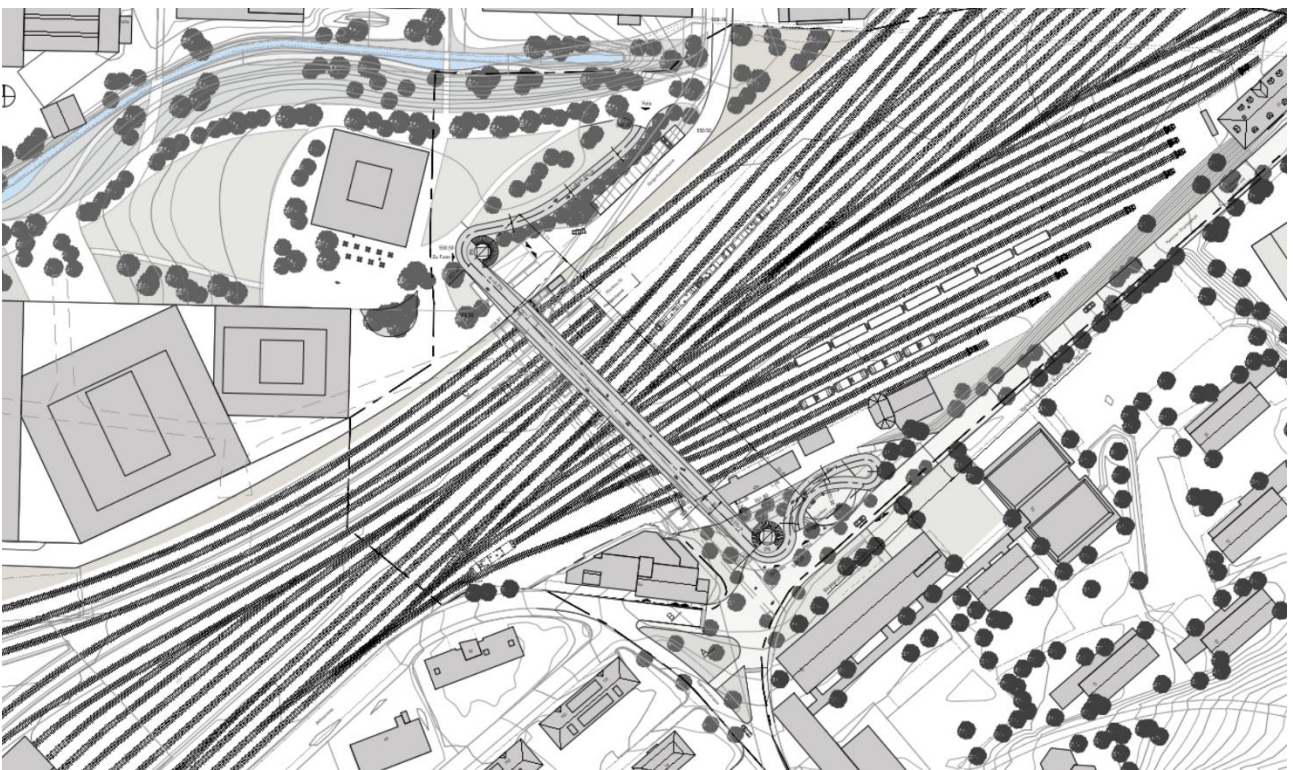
Passerelle Fuss- und Veloverkehr, Siegerprojekt Scursun (Team Furst Laffranchi Bauing. GmbH 2020)
